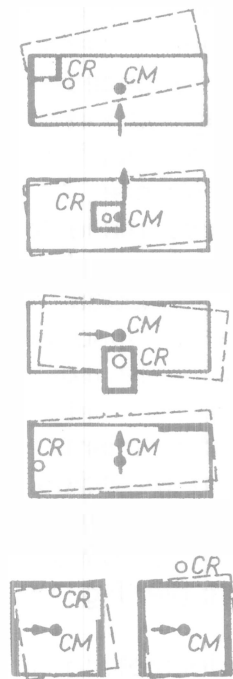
Distribución asimétrica de muros en planta (Paulay y Priestley, 1992)
